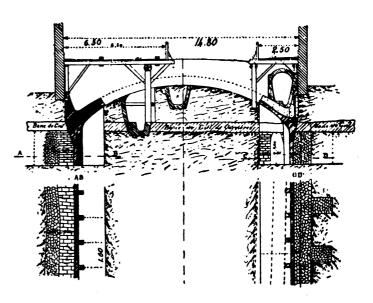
e 43. — Stazione dei Volontaires - Sezione e pianta.
